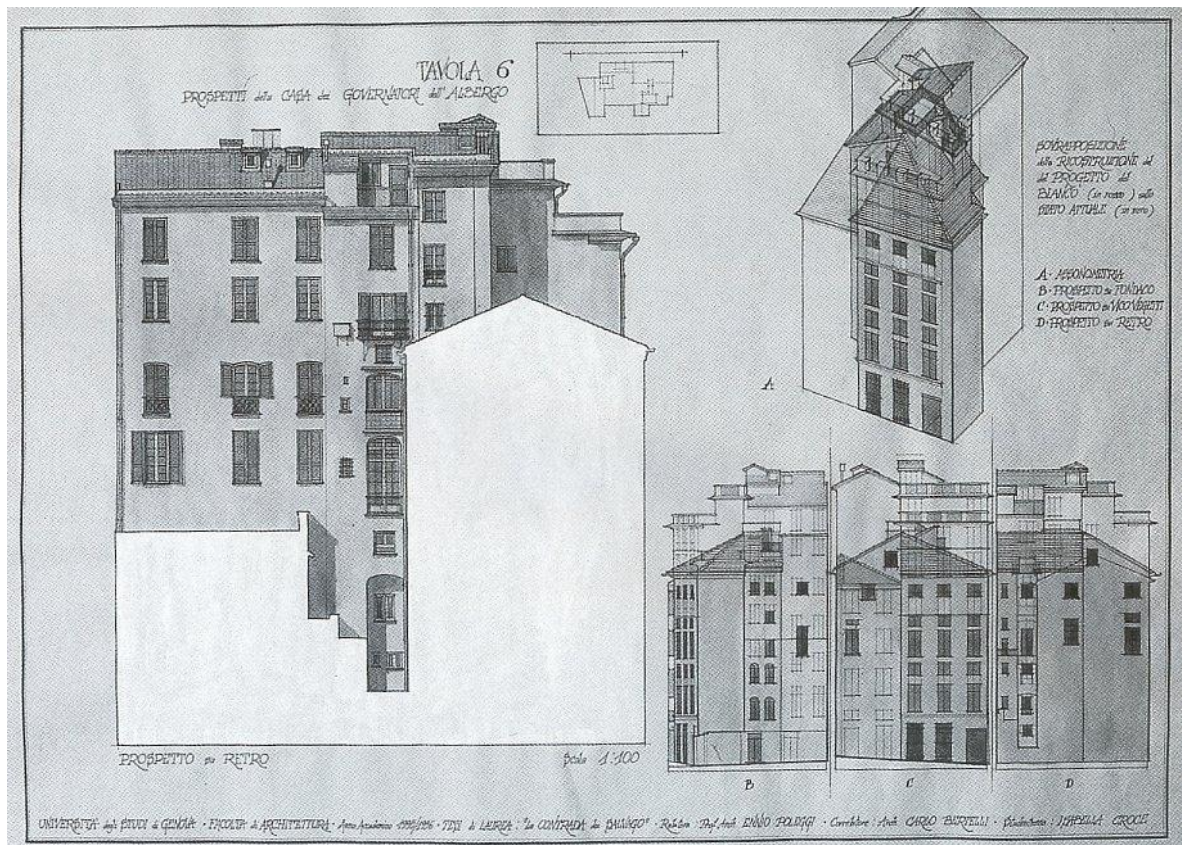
Prospetto sul retro; a destra sovrapposizione, sullo stato attuale, della ricostruzione del progetto del Bianco.
